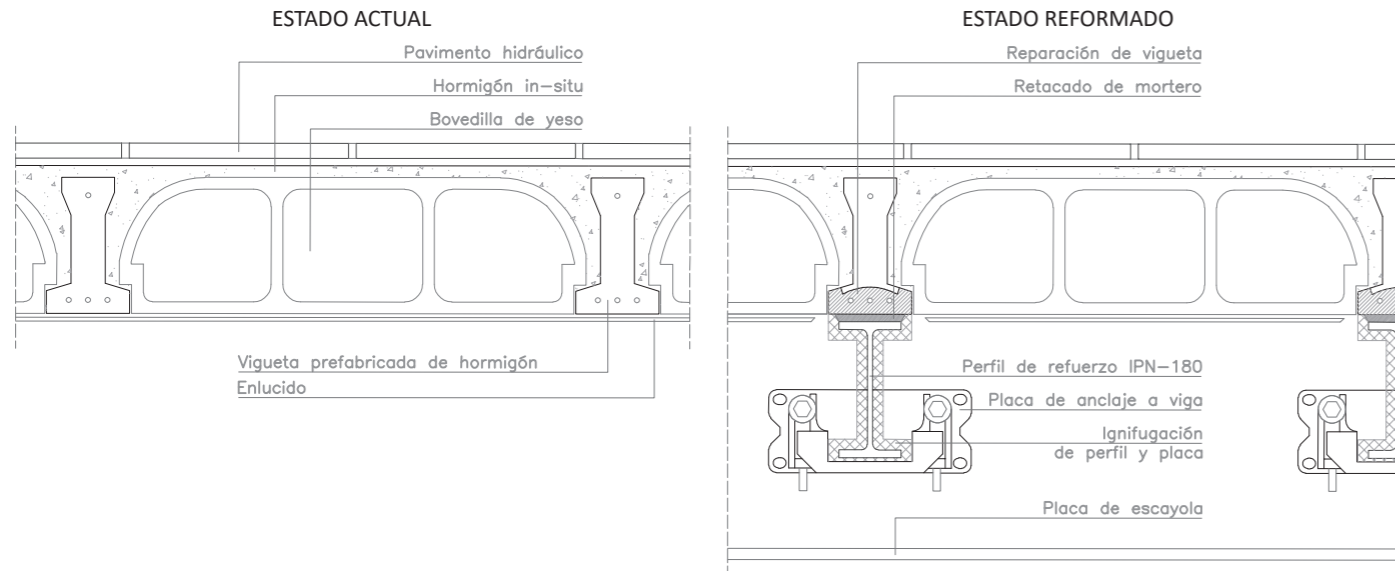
Detalle constructivo. Refuerzo de viguetas bajo zonas húmedas.
